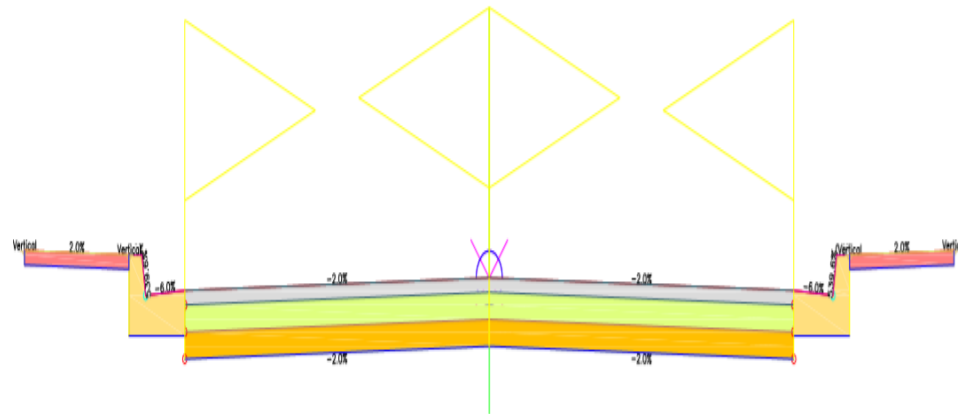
illustre le profil en travers type de la chaussée aménagée.
